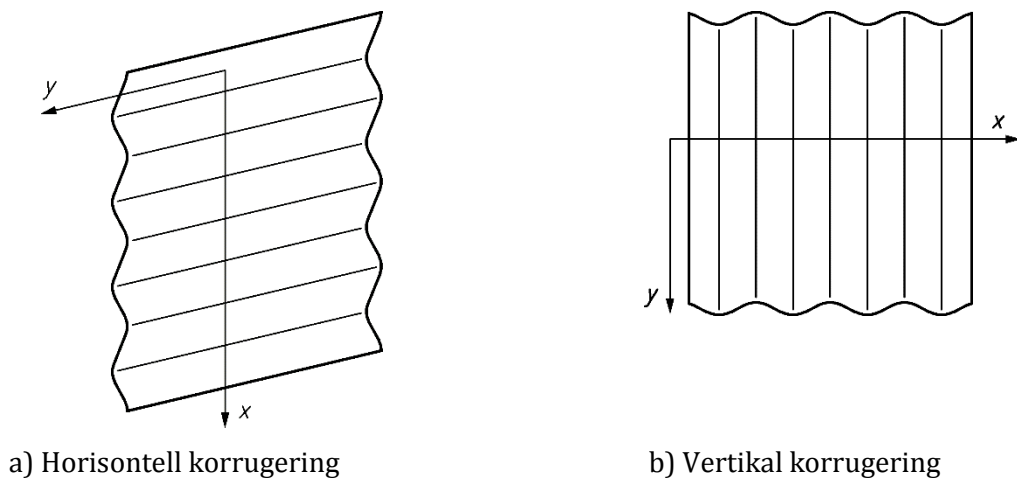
Korrugerad plåt och siloväggorientering
